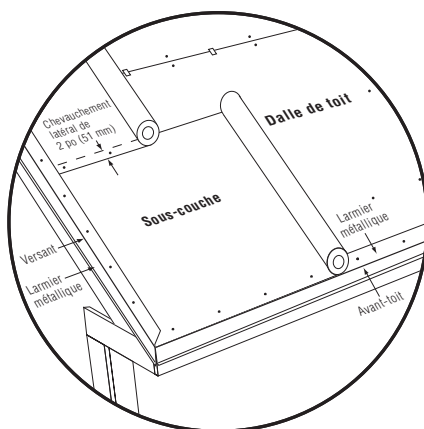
Pose d'une sous-couche étanche le long de l'avant-toit et du versant
